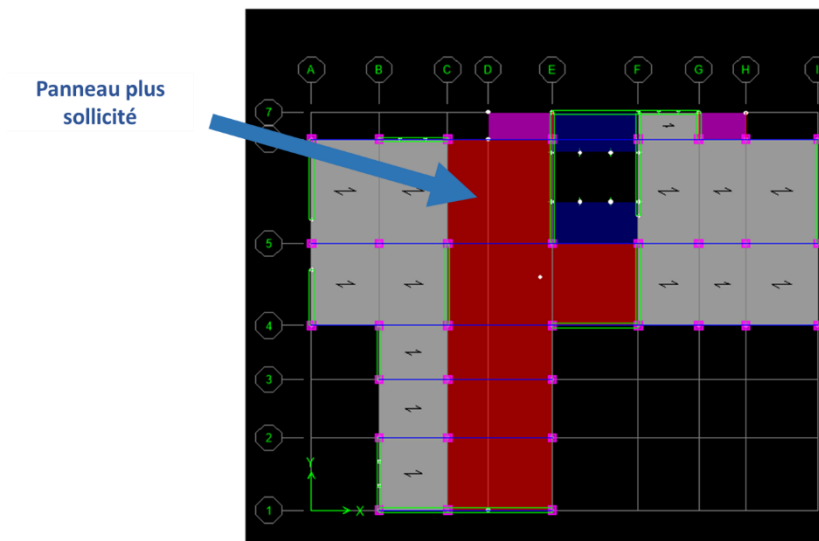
Le panneau le plus sollicité de la dalle pleine
